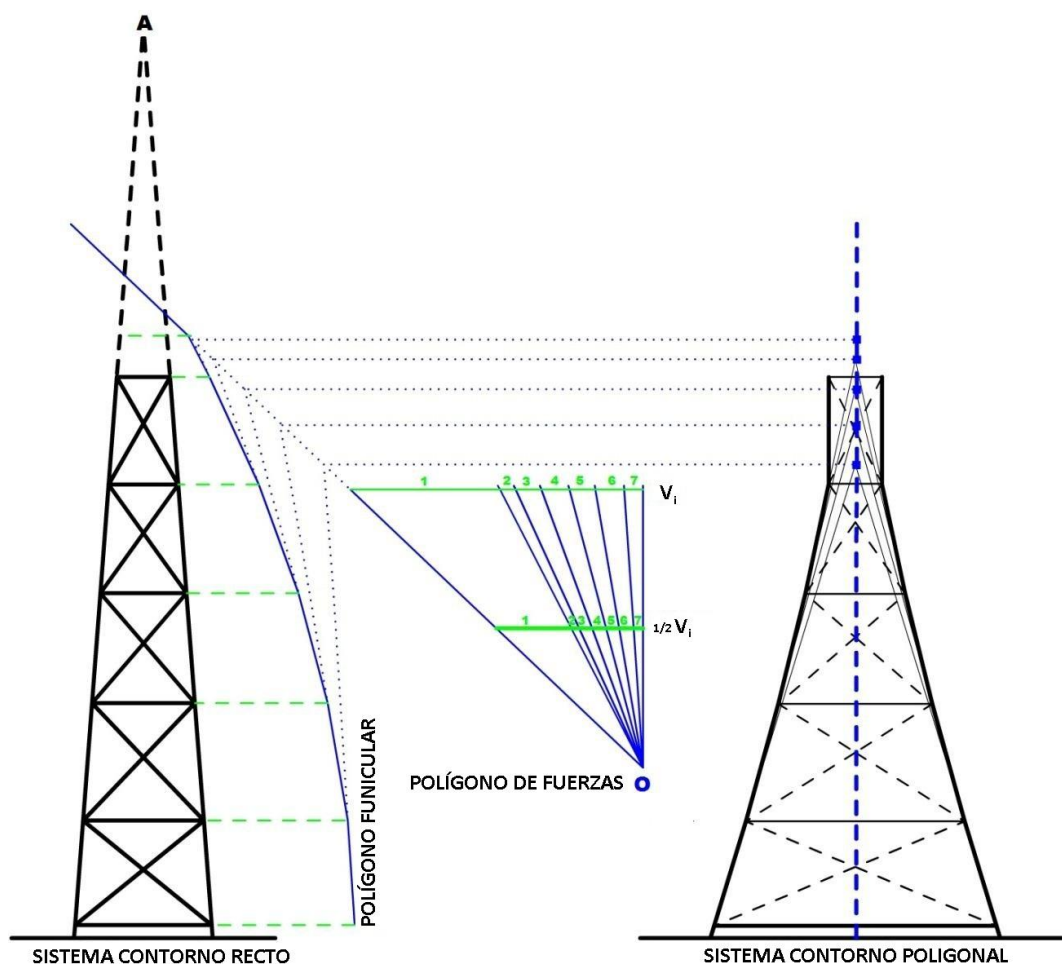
Recreación de parte de la Planche II del libro de Koechlin *Applications de la statique graphique*. Baudry et Cie. : Paris 1889. (Arrondeau, Pierre, 2011 : 19) Se adapta la forma del perímetro de la pilastra, a la forma del polígono funicular, con la consecución de esfuerzos nulos en las diagonales de la estructura.
